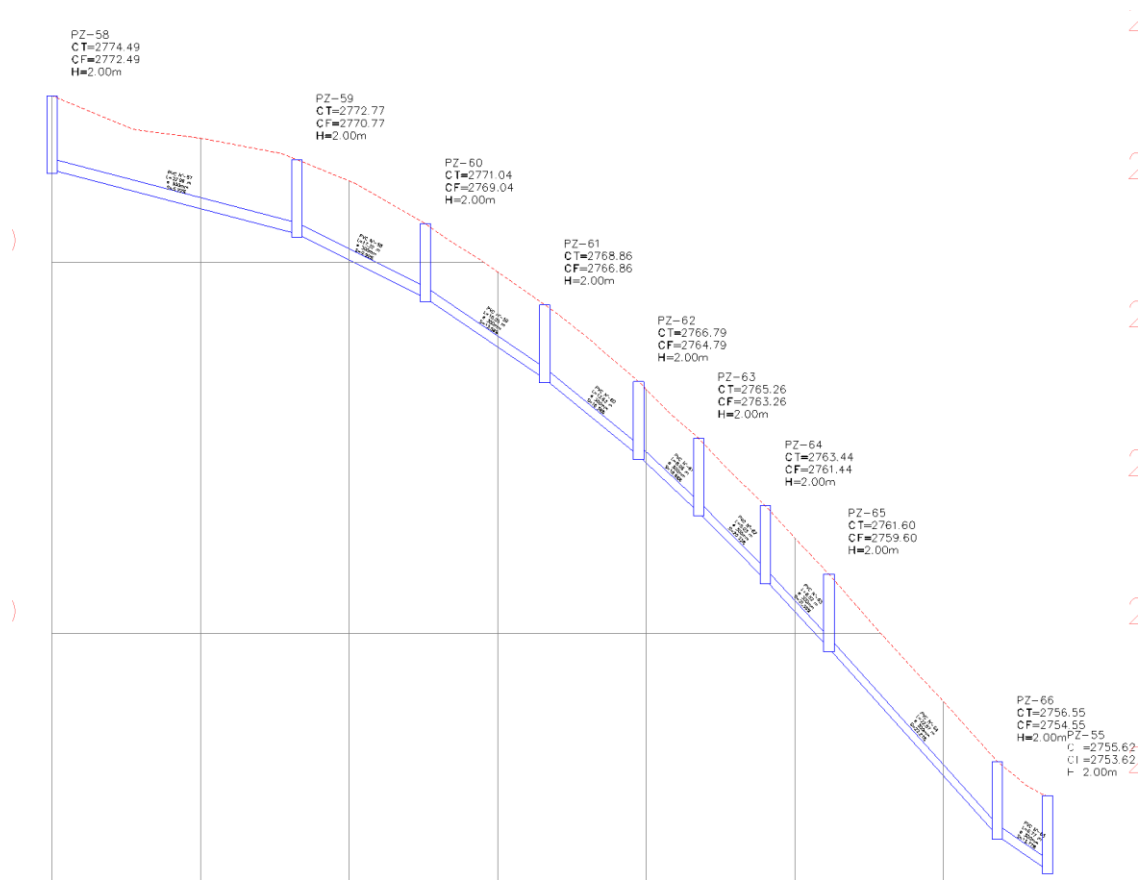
Distribución de red de alcantarillado vista en perfil calle 5. Elaboración: Autores.
